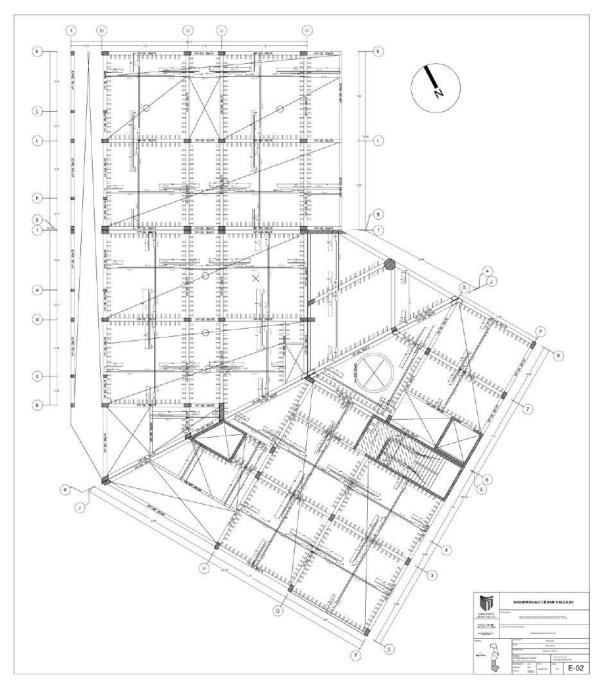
Aligerado - Primer piso sector B - ESTRUCTURAS
